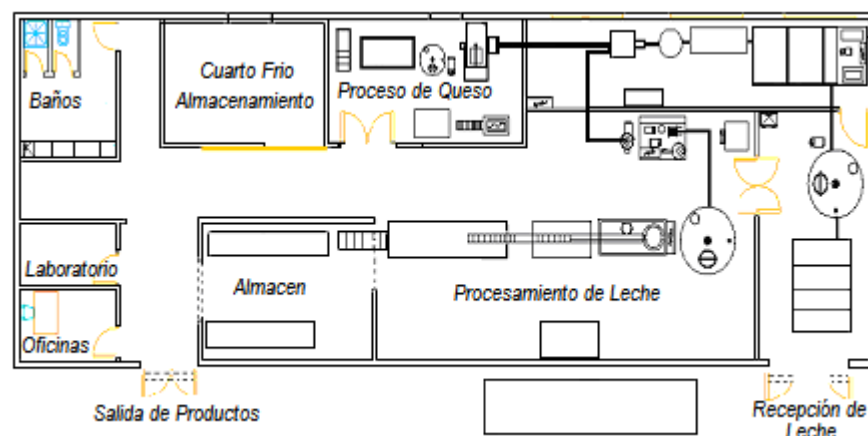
Plano propuesto para la Planta de Procesamiento de Lácteos
